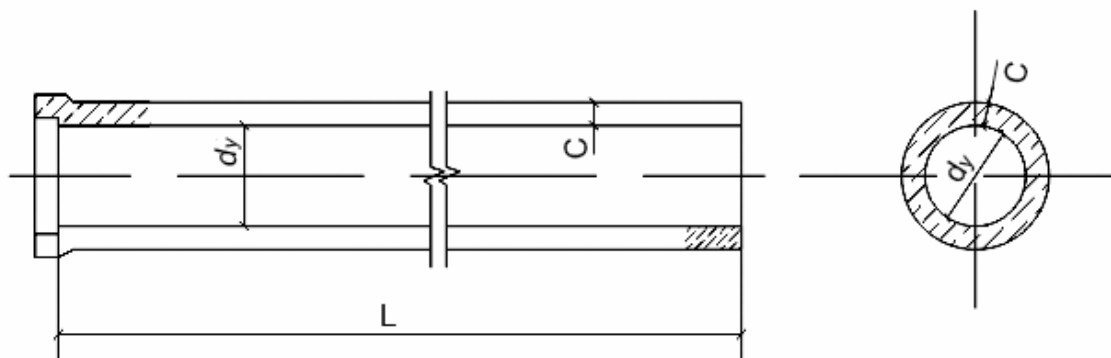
Трубы железобетонные безнапорные типа РТ
